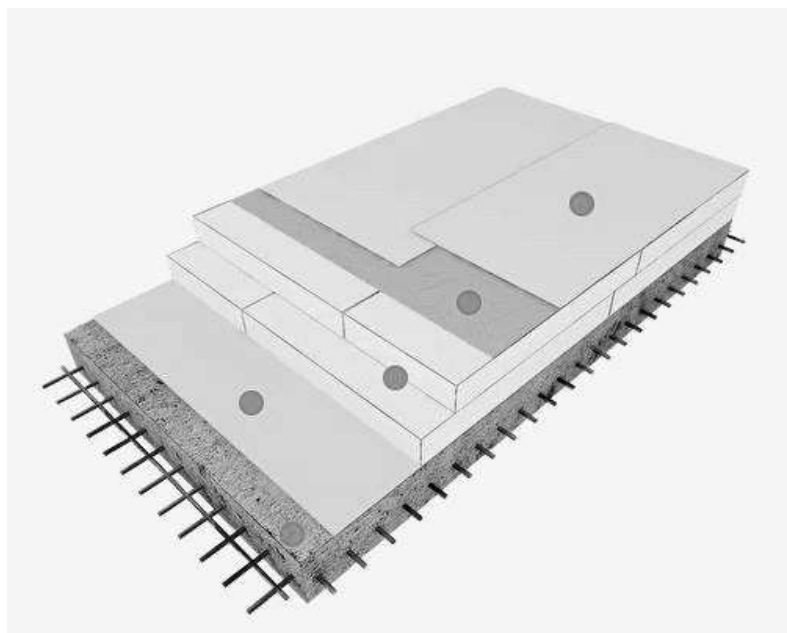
Устройство теплоизоляции перекрытия по ж/б плите
